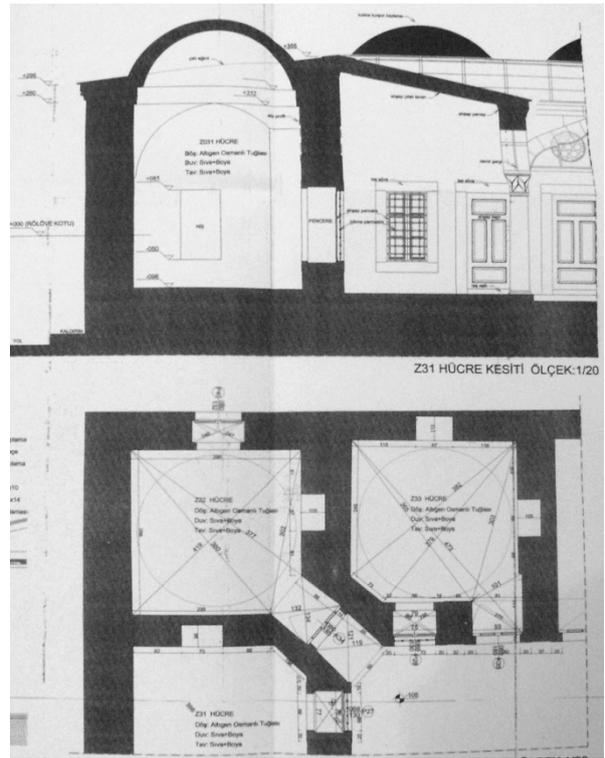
Restaurierungsplan, Schnitt und Grundriss des Derwishzimmers, 2007
